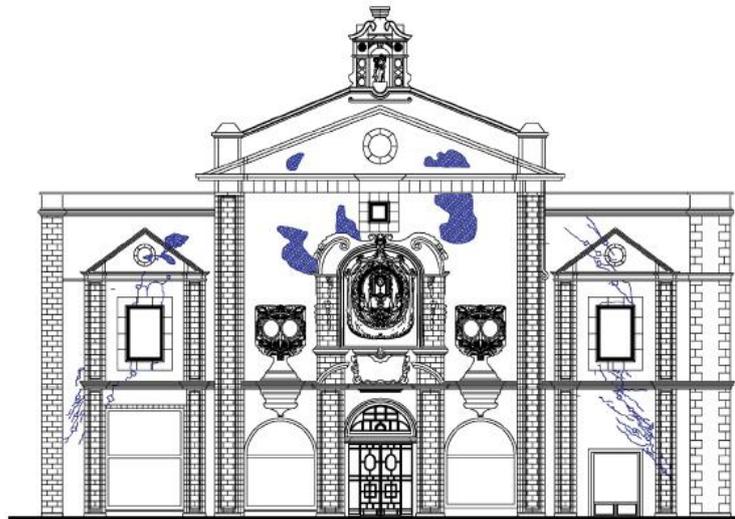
Levantamento de fissuras da fachada frontal da mesma edificação em alvenaria estrutural
